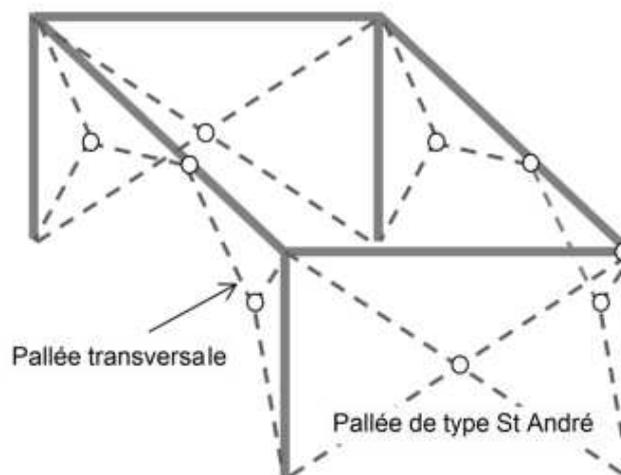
exemple de l'ajout d'un contreventement métallique
